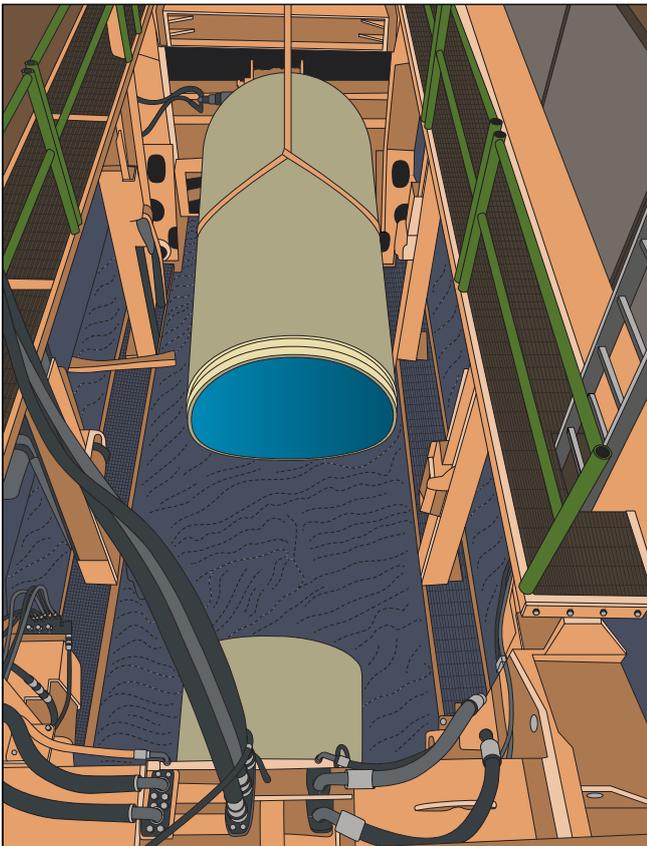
Transporte de perfis de tubos no poço de instalação de fluxo com cintas
